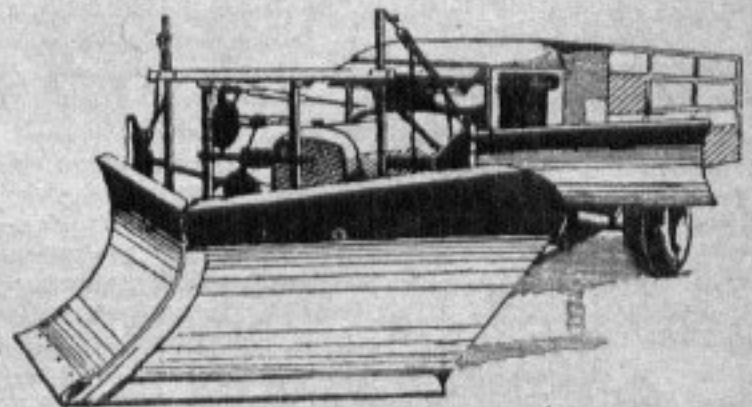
Комбинированный двухотвалный плужный автомобильный снегоочиститель с дополнительными боковыми крыльями
